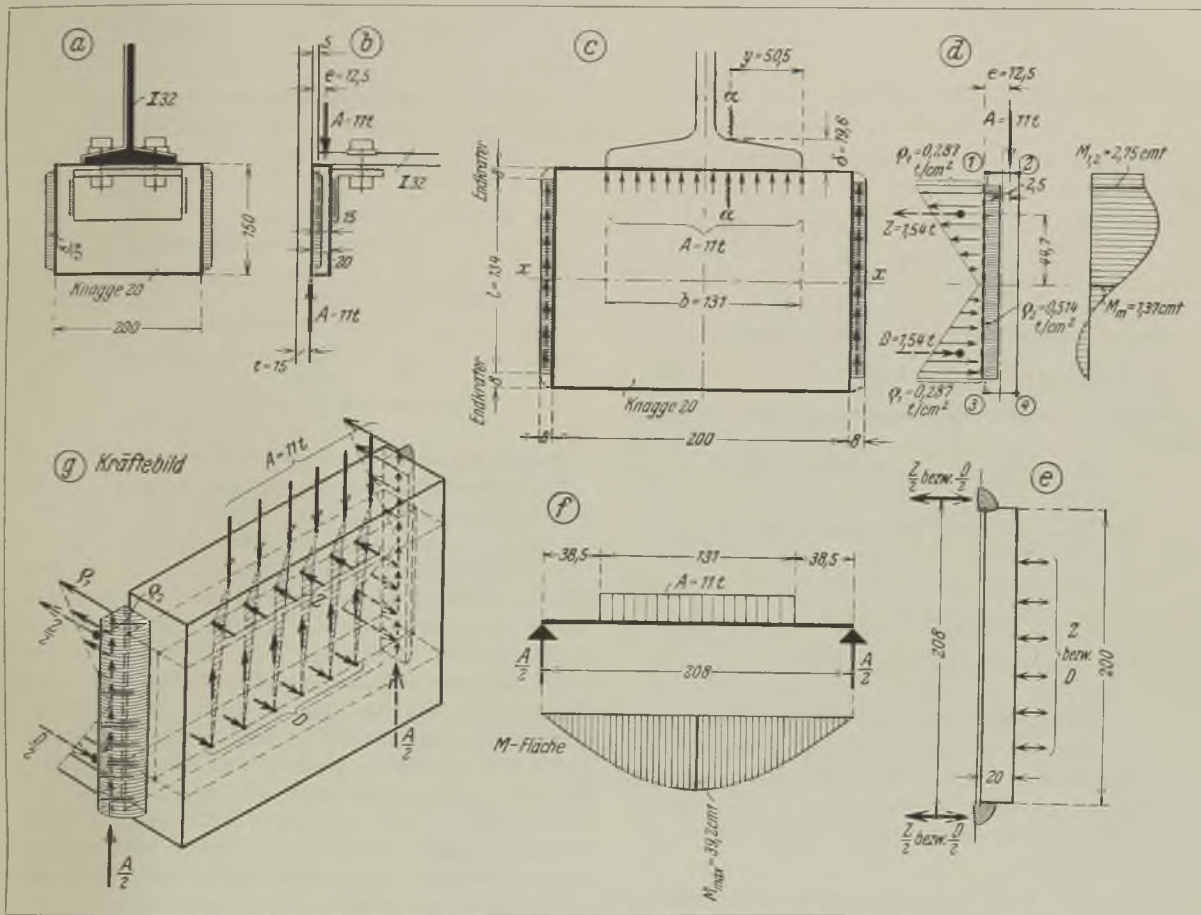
Trägerrauflager auf eine Stützknagge, die mit zwei Flankennähten an die Stütze angeschweißt ist.
